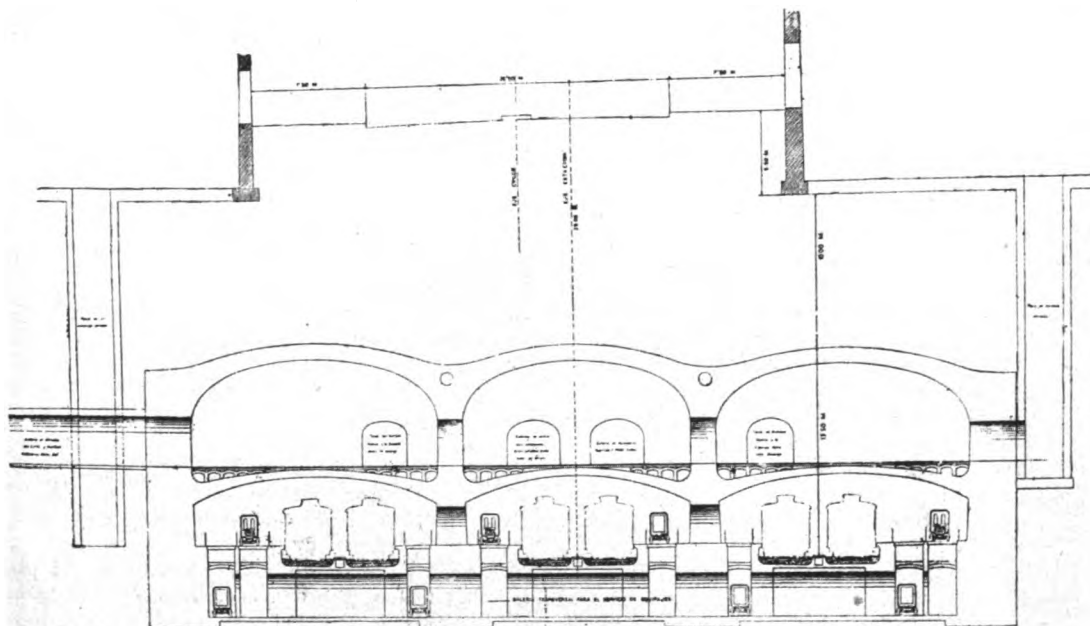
Sezione trasversale della stazione centrale di passaggio di Madrid.
